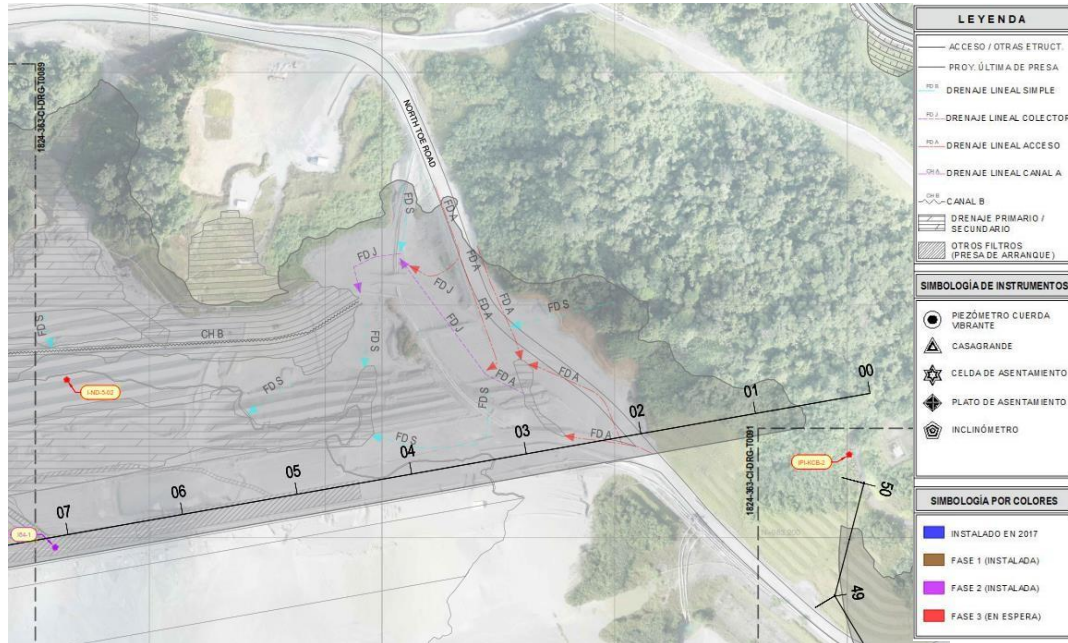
Inclinómetro en Presa Norte Sector 1 (ND Sector 1-cofferdam)
